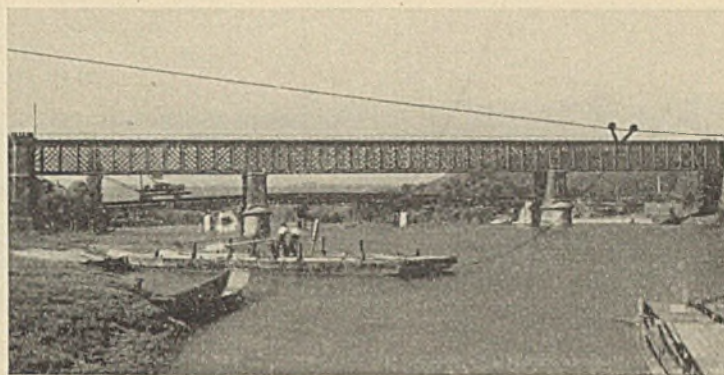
Durchblick unter Eisenbahnbrücke nach der neuen Straßenbrücke.
